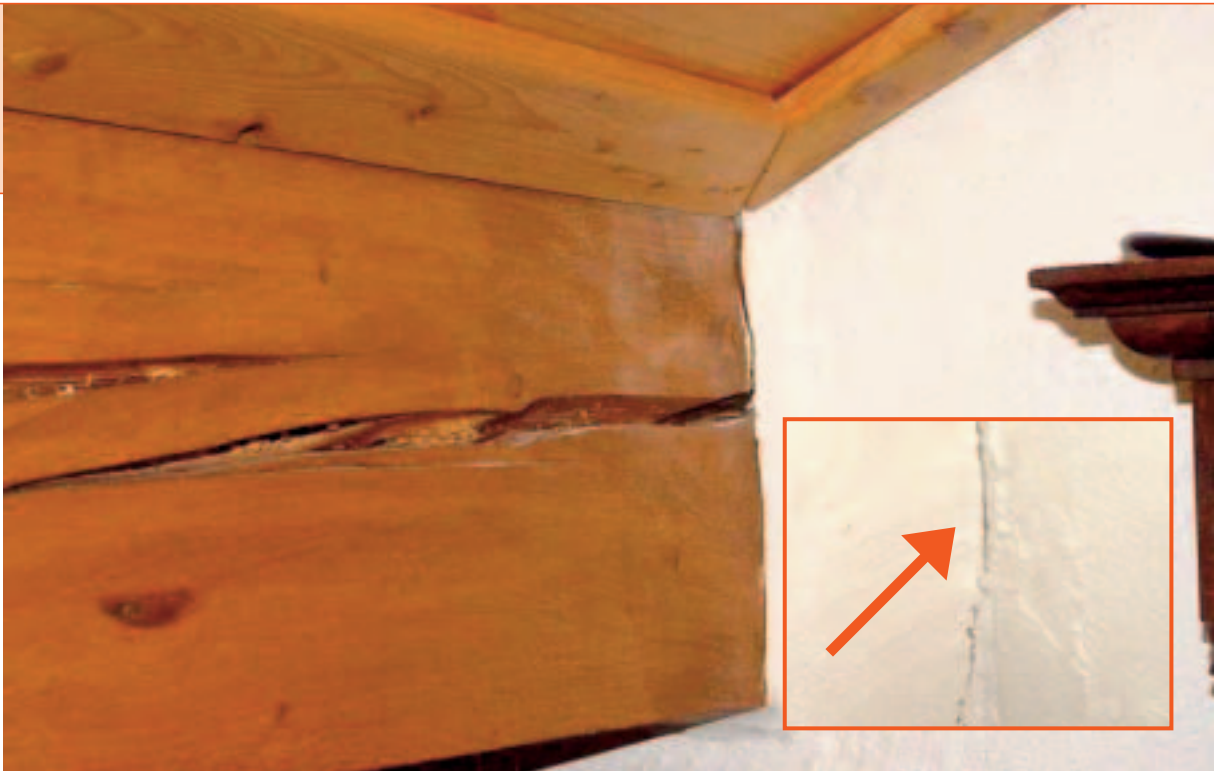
Risse im Mauerwerk und im Bauholz wurden als Schneedruckschaden „verkauft“ (Schaden für Trittbrettfahrer).
